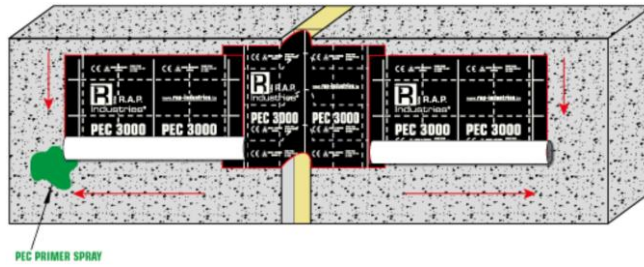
Étanchéité à l'eau au droit des joints de dilatation
